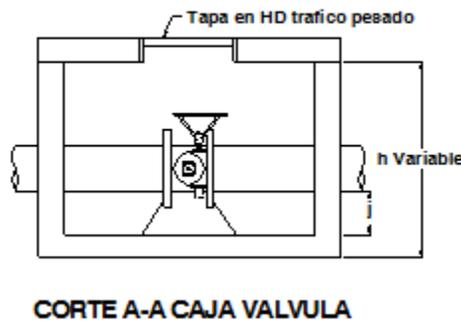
Caja en Mampostería Reforzada
